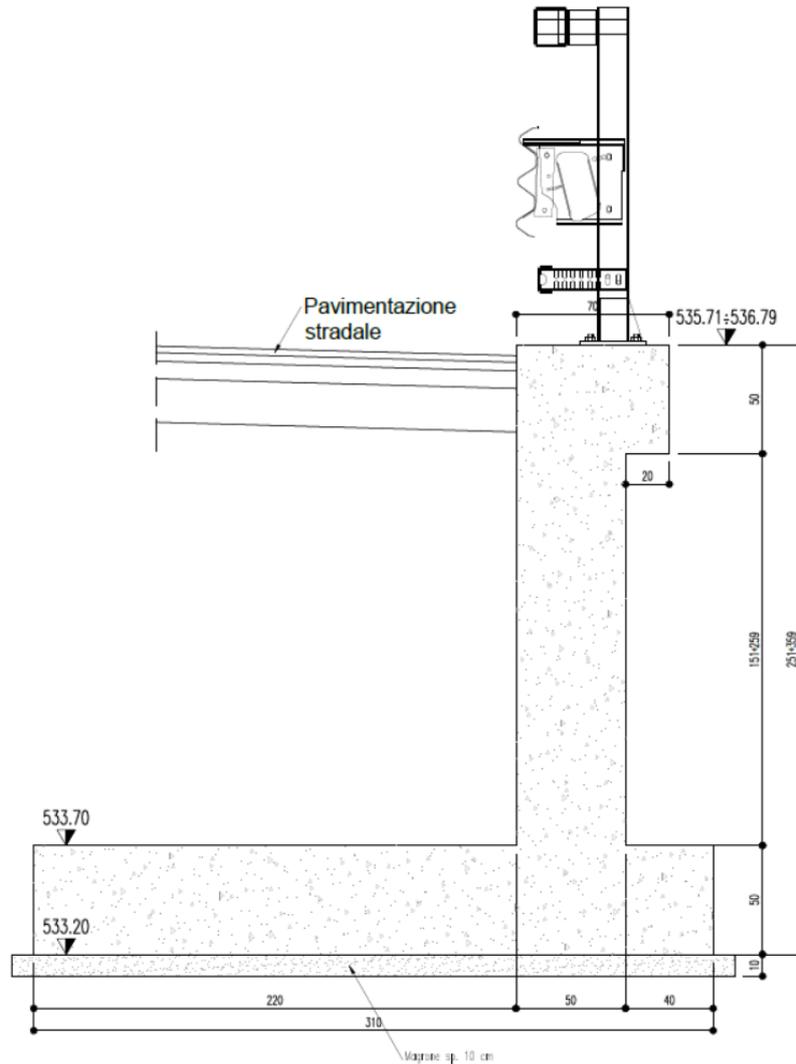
Carpenteria tipo del muro su fondazione superficiale parallelo alla viabilità NV062
